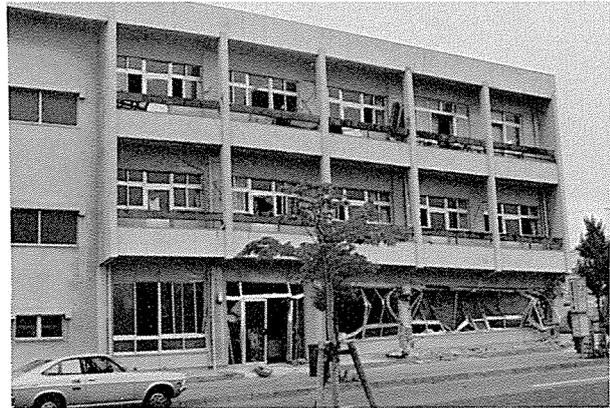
1階柱が破壊し倒壊した建物(他社施工)
